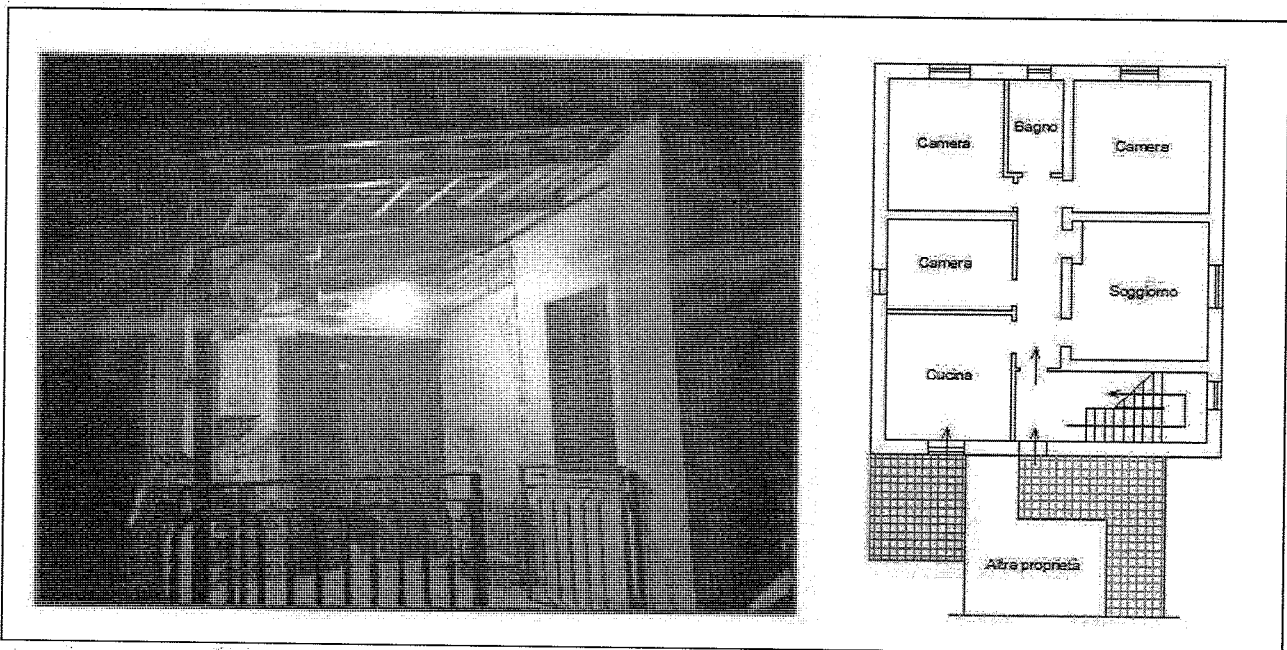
Immagine della tettoia esterna ed indicazione della stessa nella planimetria con colore rosso.
